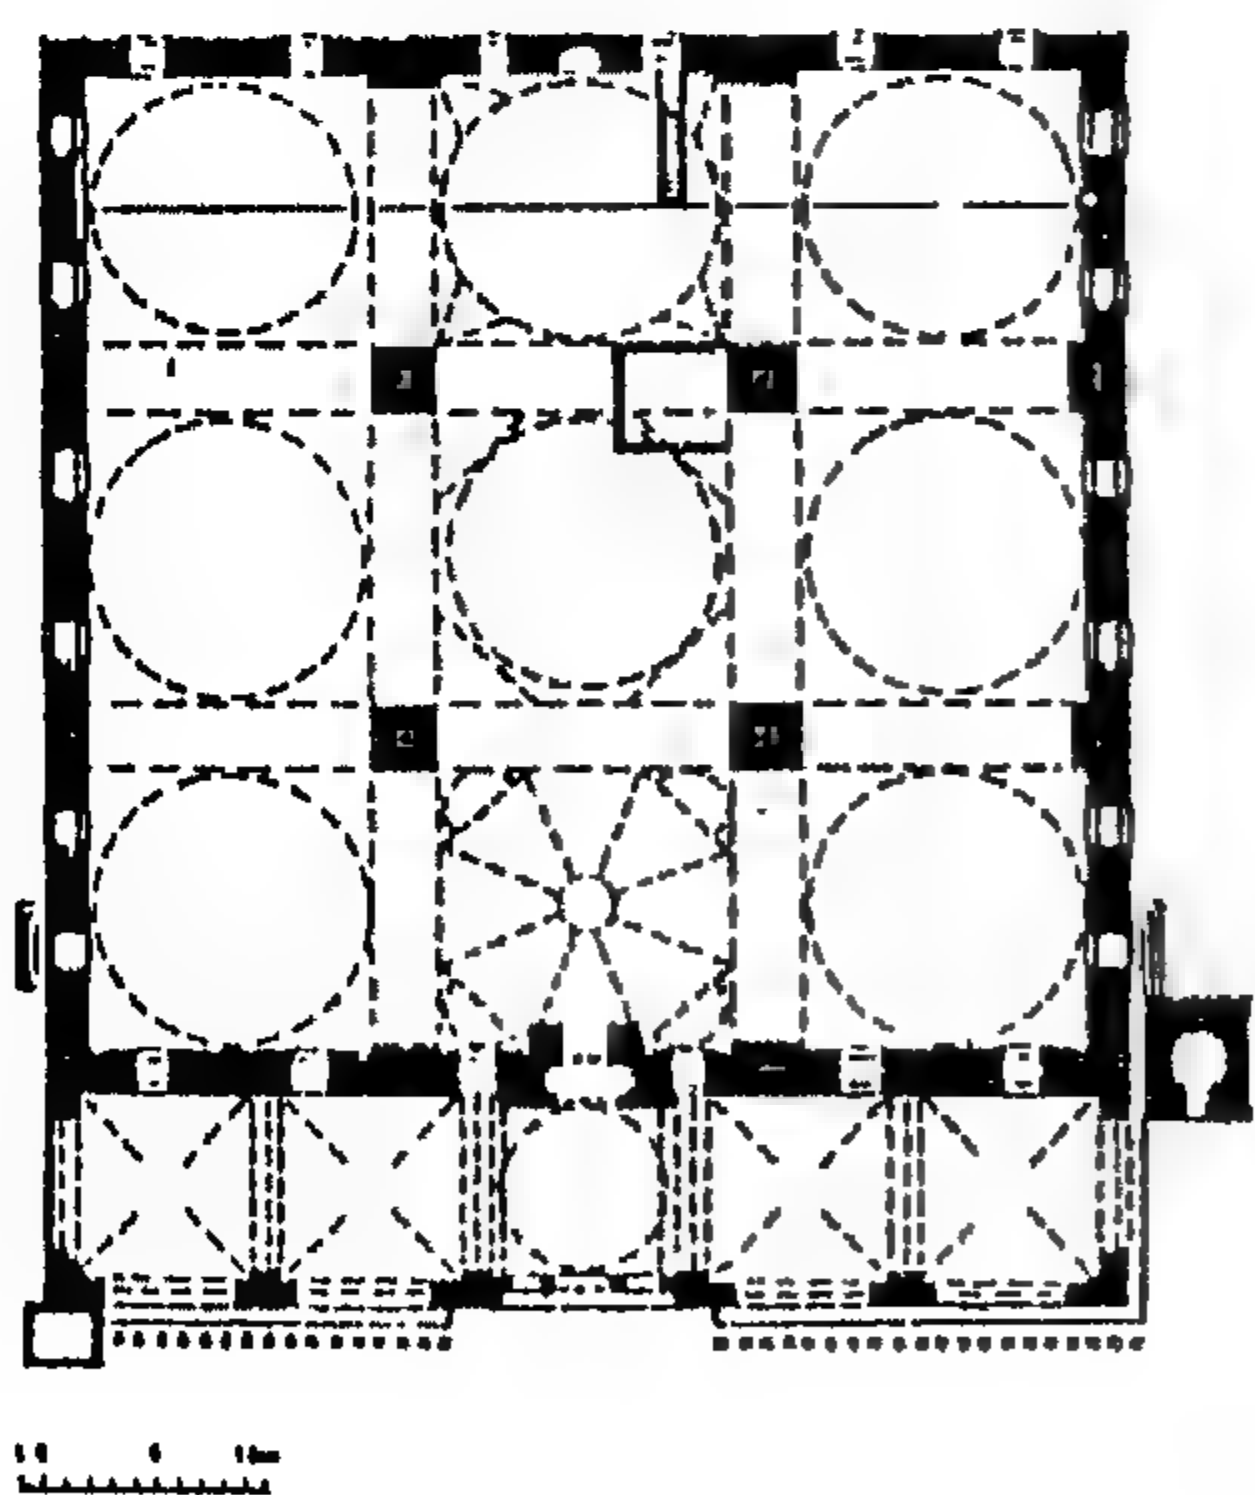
مسقط أفقي لمسجد بلخ في أفغانستان . (عن : Golombek) .
